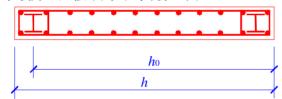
两端配有型钢的钢筋混凝土 剪力墙斜截面受剪承载力计算
